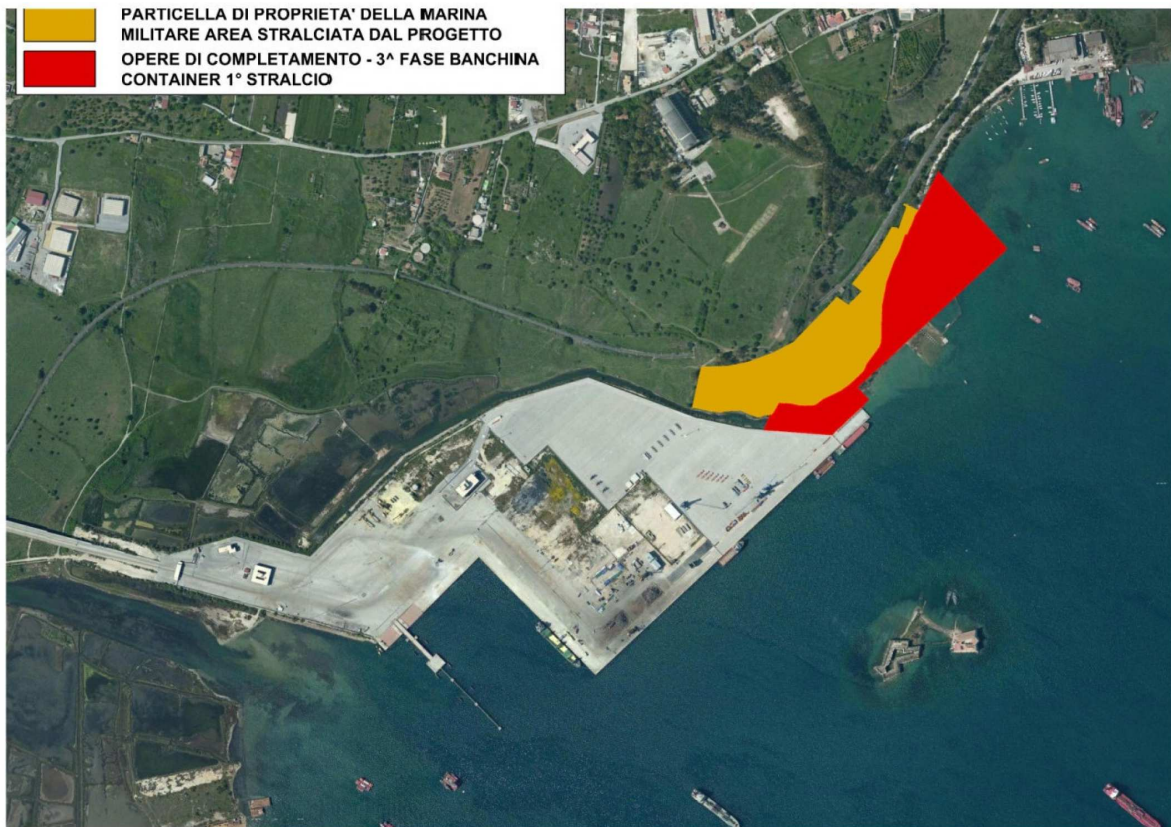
Progetto esecutivo di 1° Stralcio.
